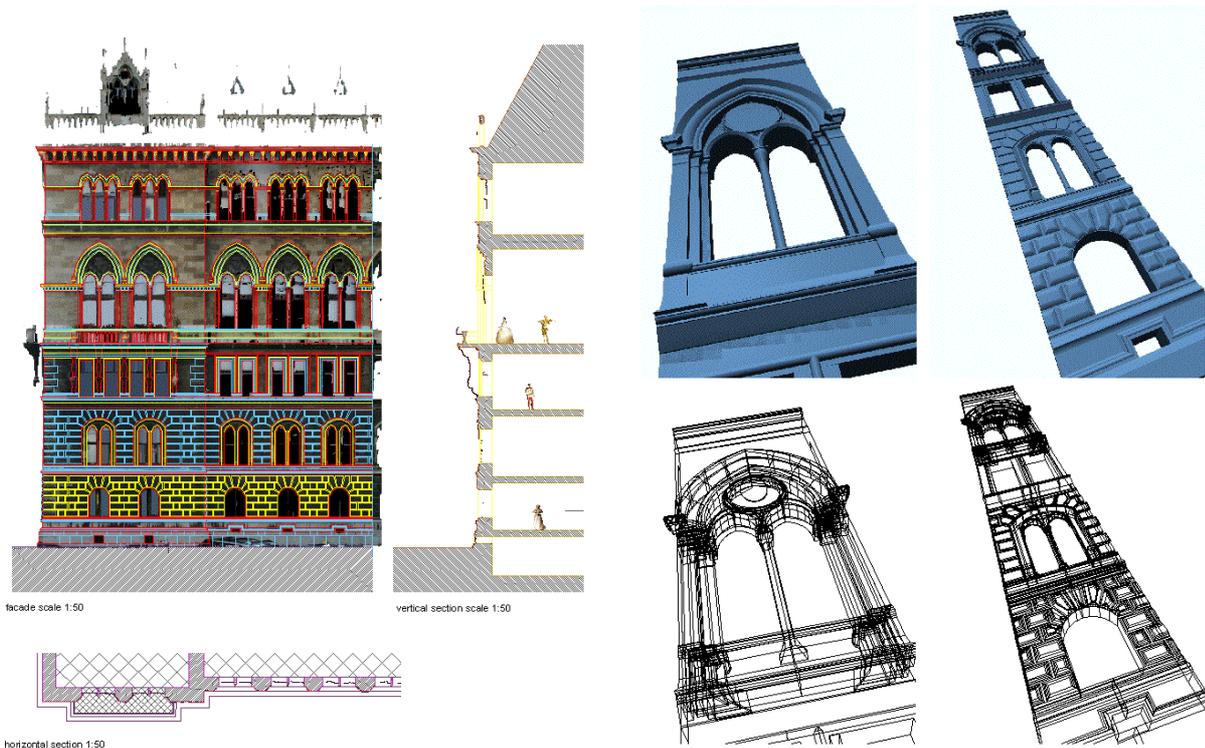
3D Strichauswertung der Fassade und Detailauswertung einzelner Fassadenelemente
